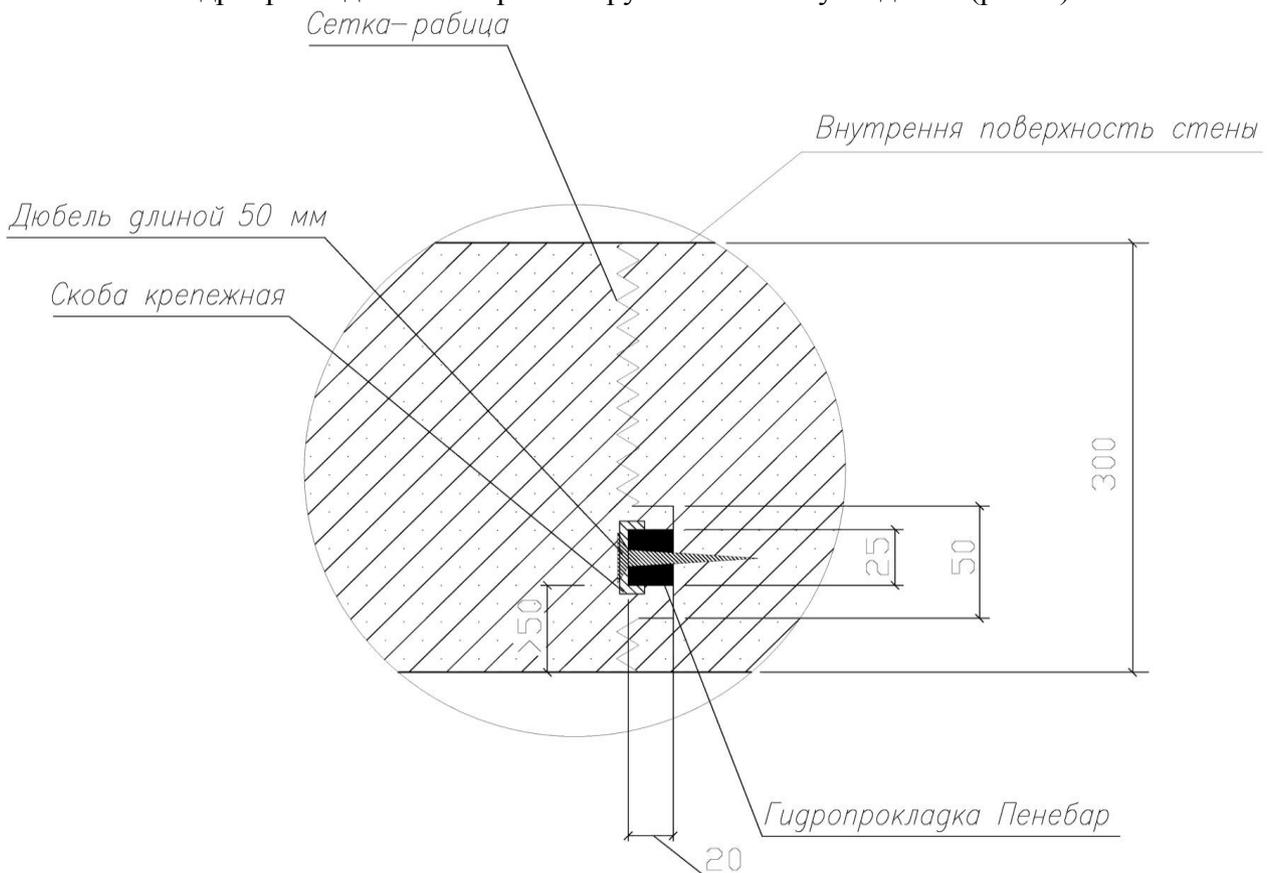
Схема установки гидропрокладки «Пенебар» в вертикальных рабочих швах
